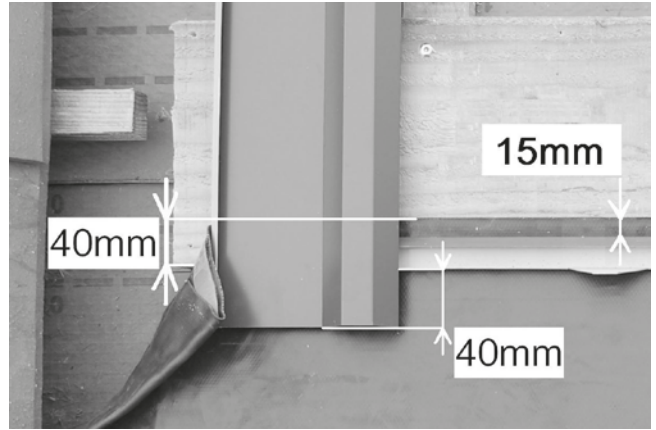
Collez 40 mm de bande Wakaflex sur la planche A de sorte à ce qu'elle dépasse d'au moins 100 mm aux extrémités de la rangée de cales de soutien afin de pouvoir replier chaque angle supérieur par-dessus les couloirs latéraux, pour arrêter les remontées d'eau.
